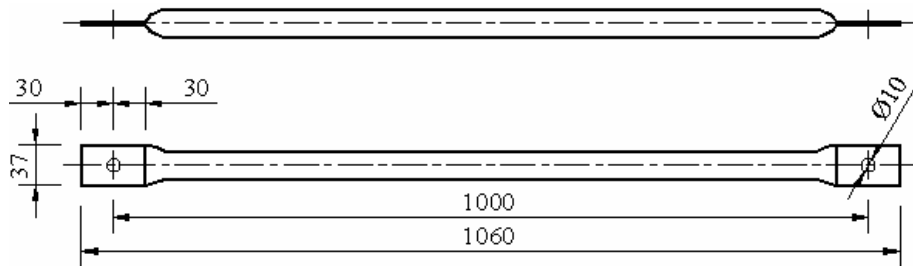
Banzo - detalhe do amassamento e furação (mm)
